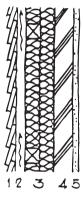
1 revêtement extérieur 2 vide d'air (ventilation)
